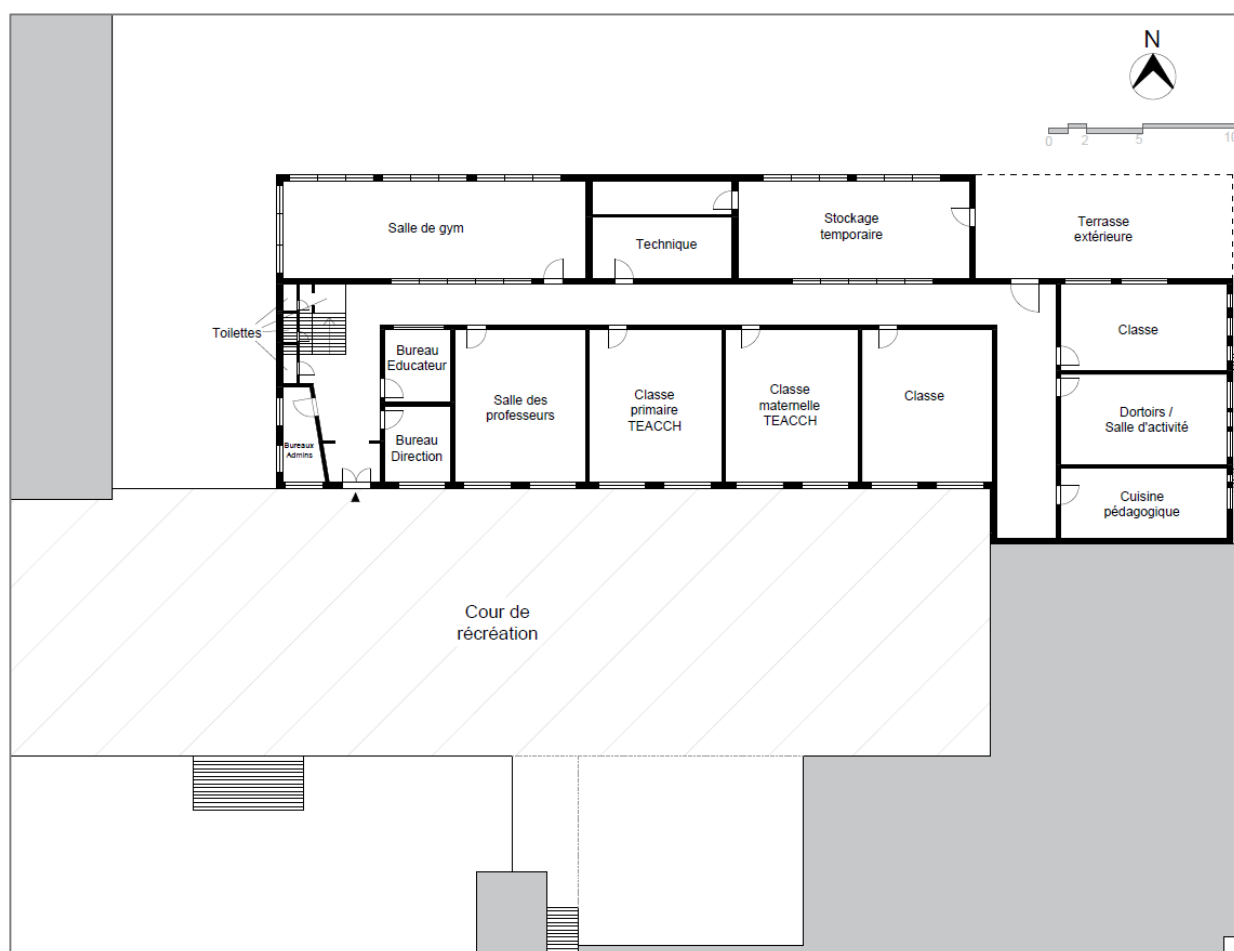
Plan du rez-de-chaussée – Saint-Joseph (Daumalle, 2026)
